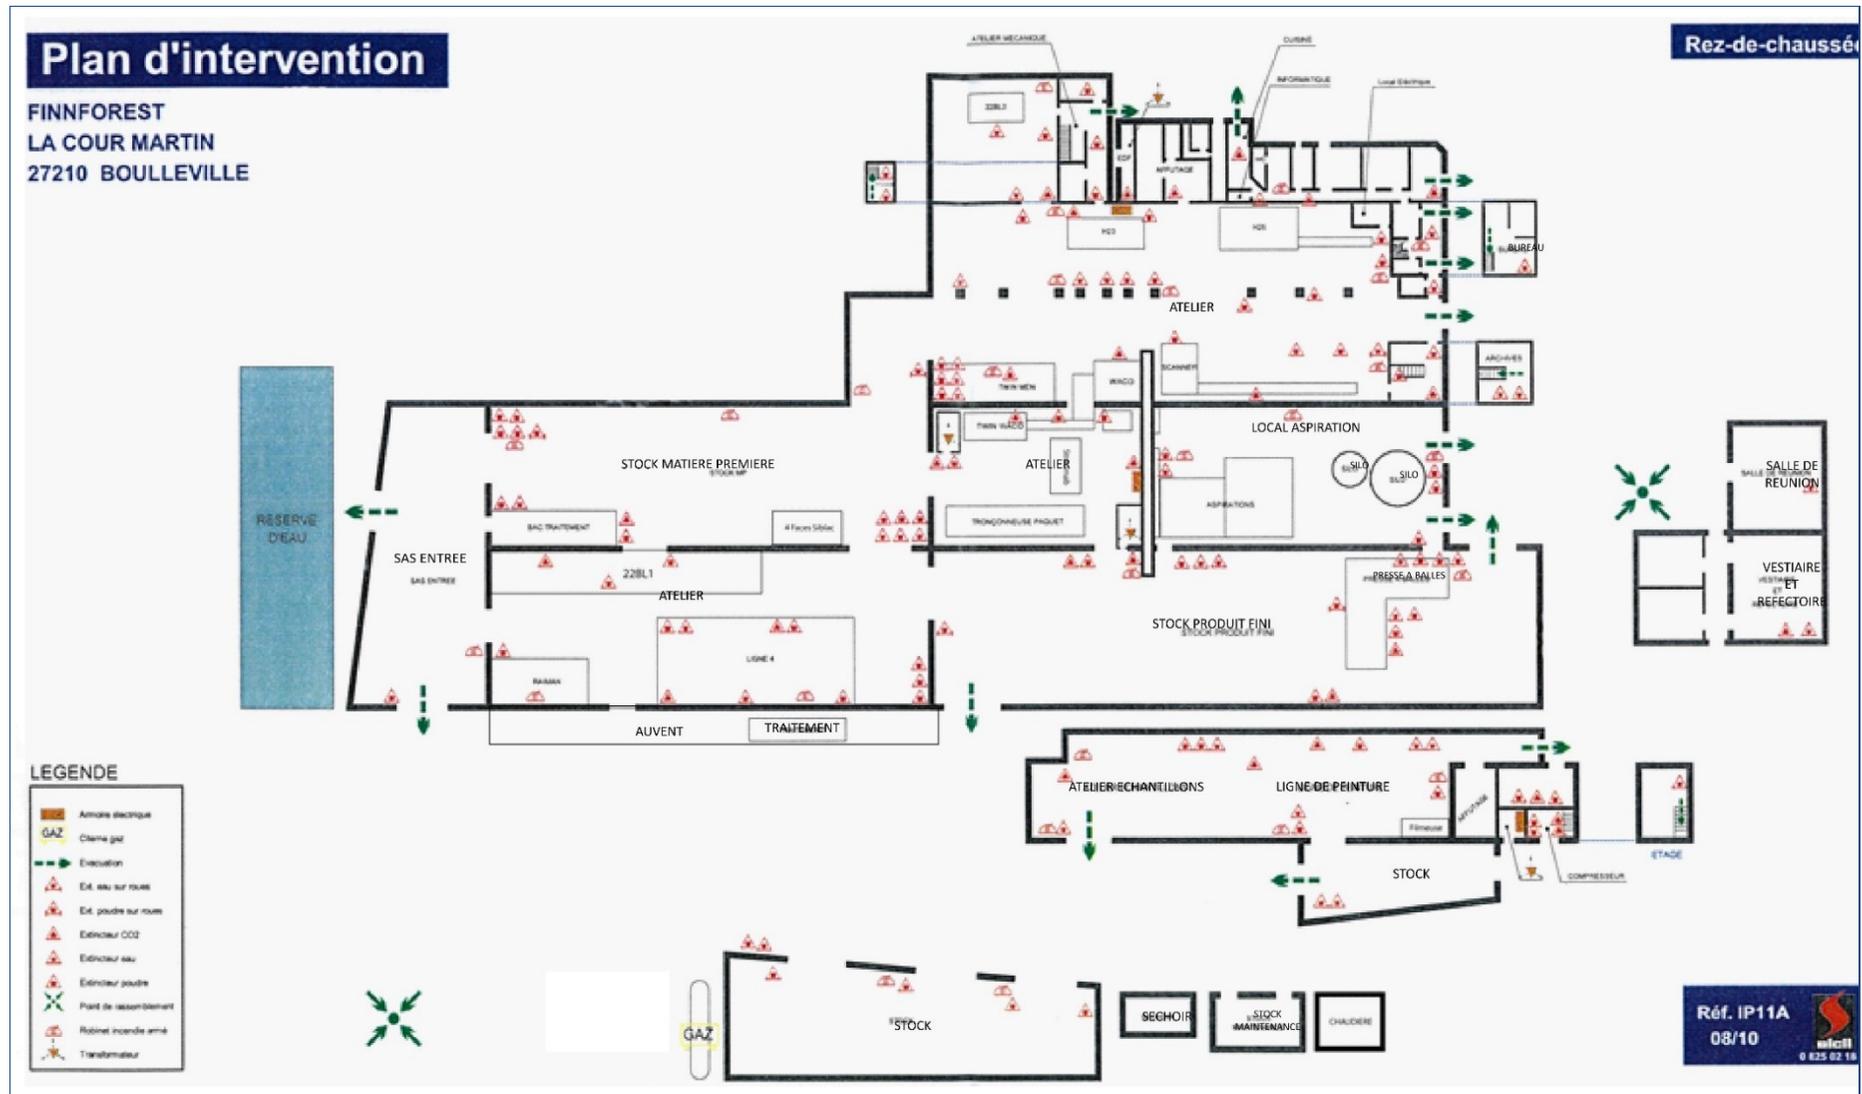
Plan d'intervention – avec localisation des extincteurs
